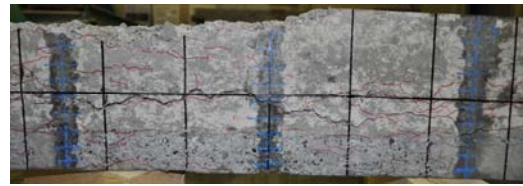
水平ひび割れ、スケールリング (C15)
